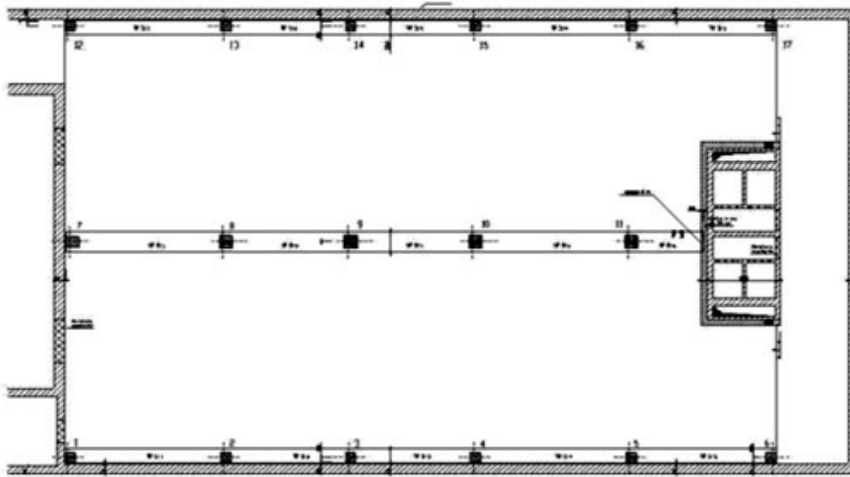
Pianta del fabbricato con indicazione del posizionamento dei plinti di fondazione.
